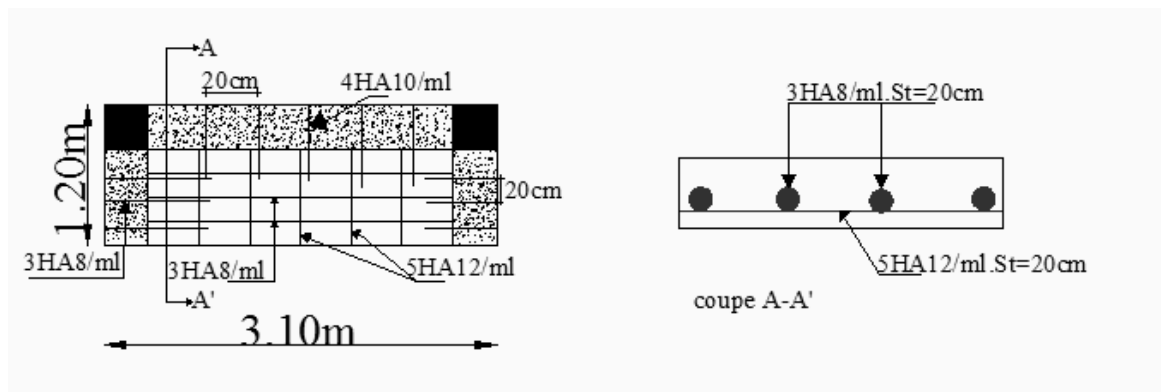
Schéma de ferrailage de dalle sur 3 appuis (balcon).
